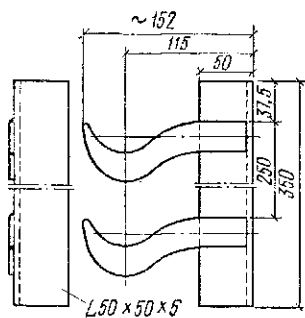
Кронштейн двойной типа 19кс для крепления регистров из гладких труб на кирпичных или бетонных стенах дюбель-гвоздями (масса 1,65 кг)
